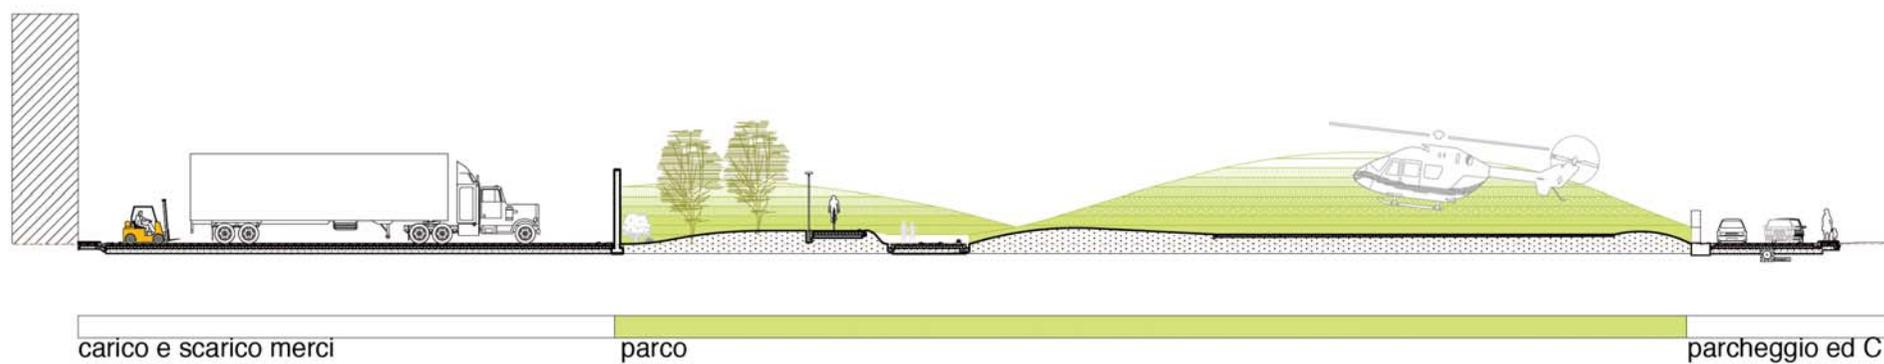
Parco Urbano Sezione 4 (Stralcio tavola UdVpPlm009 del progetto definitivo architettonico)
